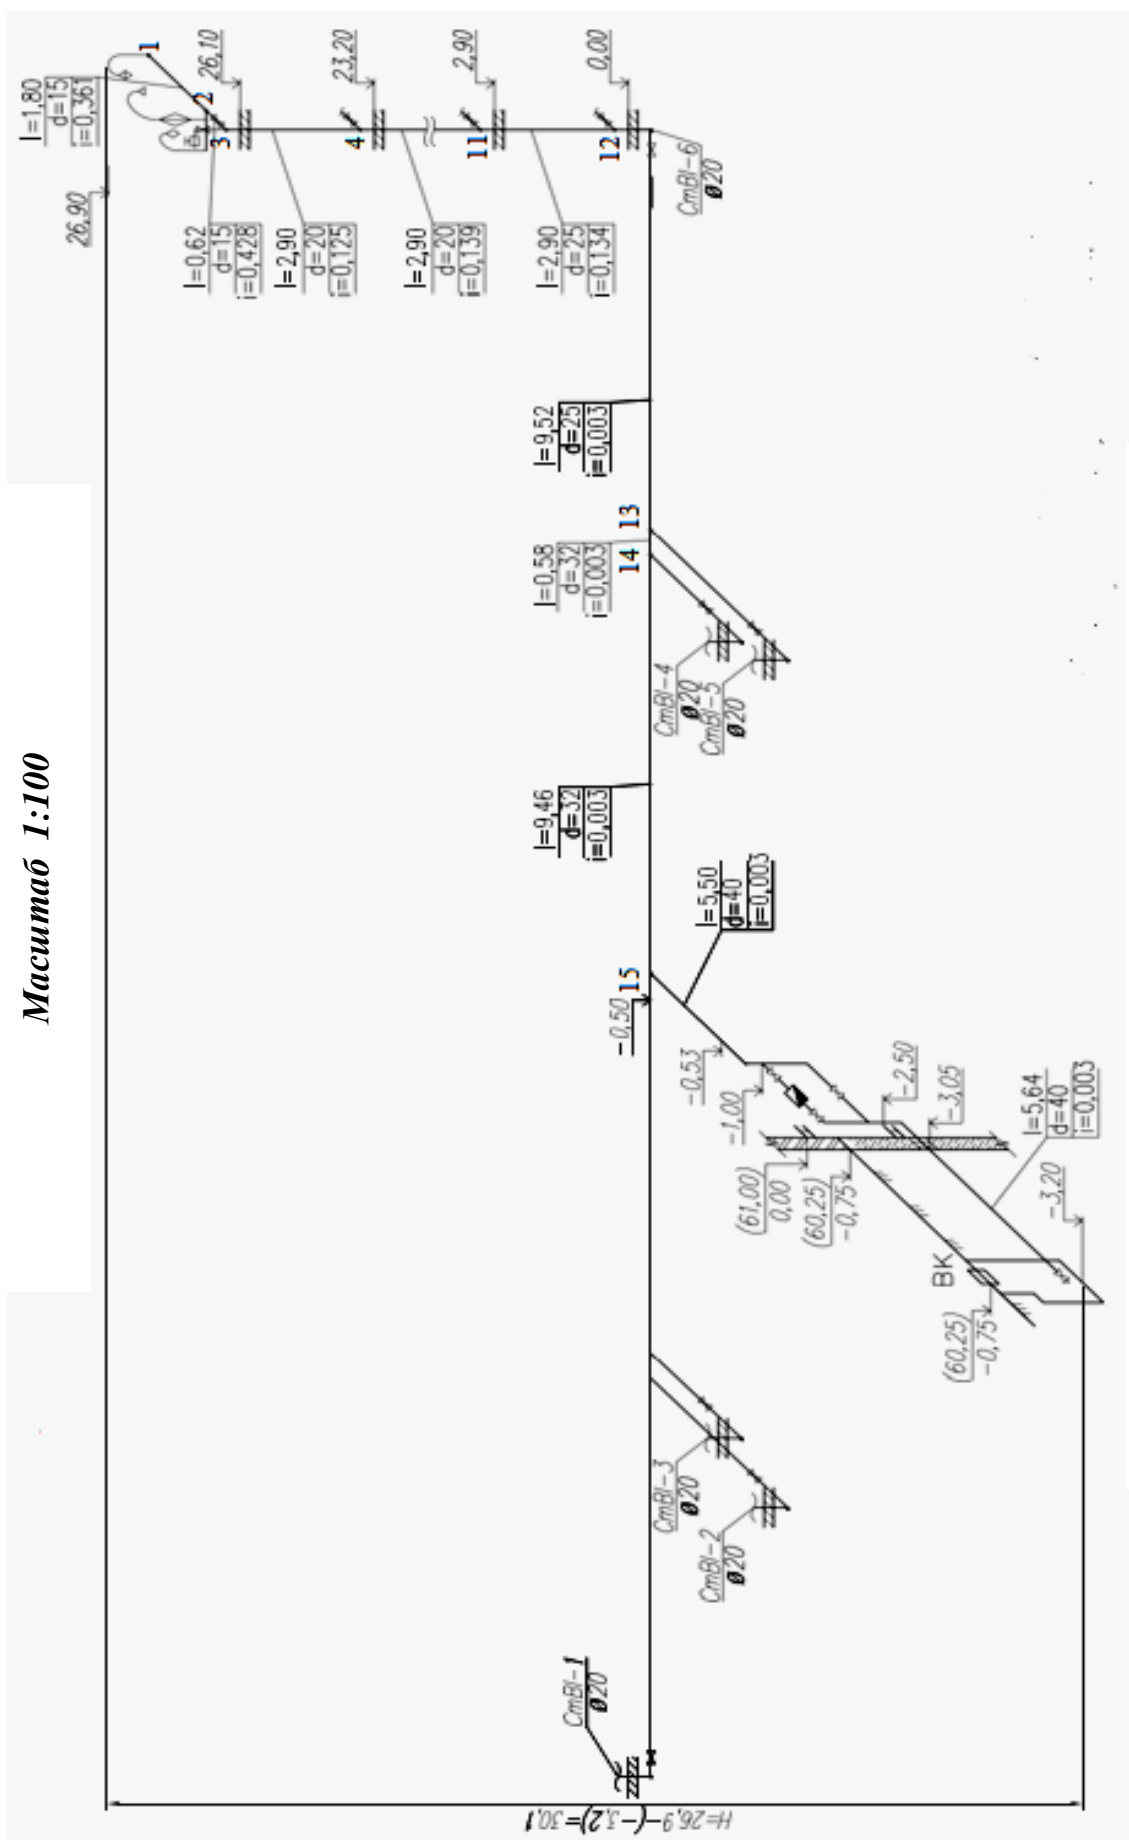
Аксонометрическая схема внутреннего водопровода
